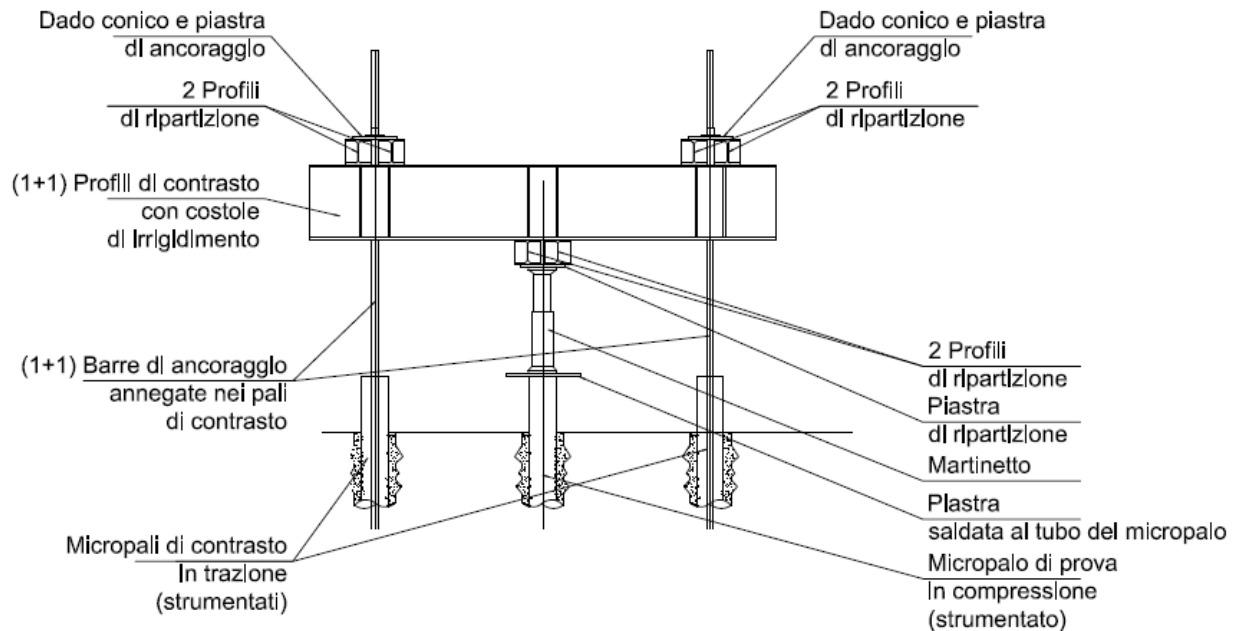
0 - Schema di applicazione del carico di prova su palo di fondazione con travi di contrasto
